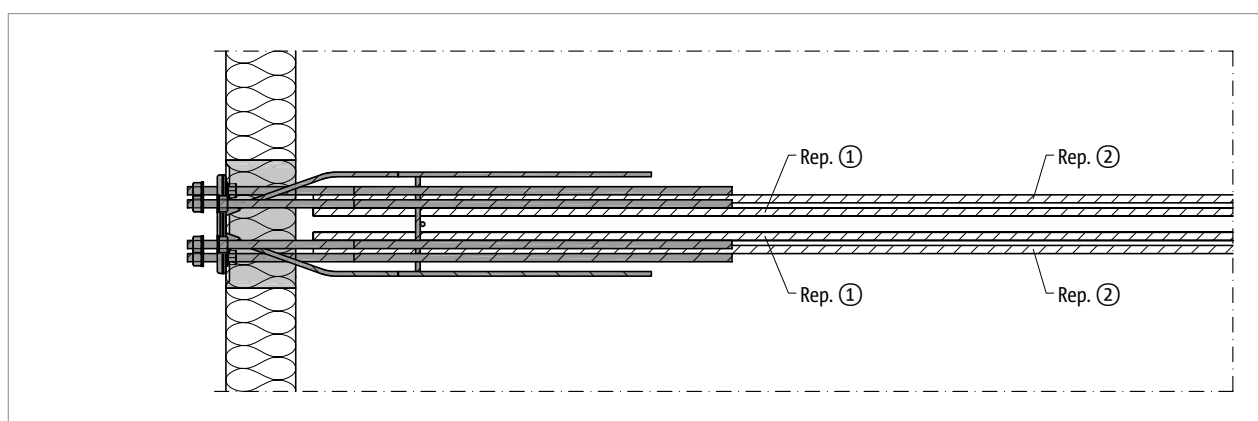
Schöck Isokorb® XT type SK-MM1-VV1 : armatures à prévoir par le client, vue en plan
